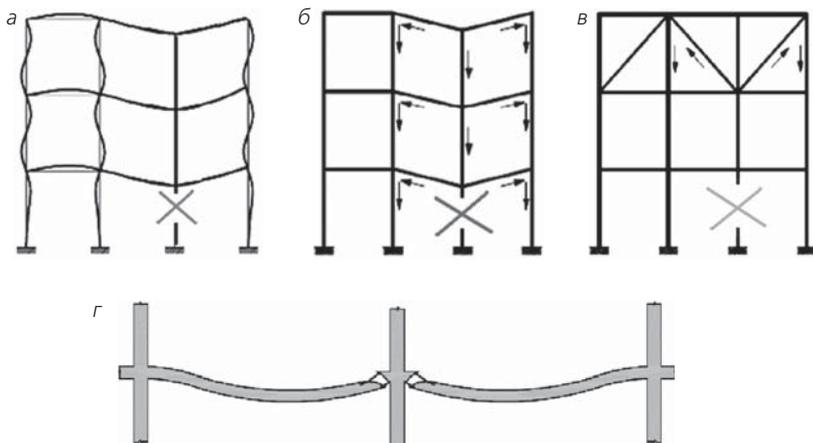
Схемы возможных сценариев работы конструкций при локальном разрушении: а – по типу «балки Виренделя»; б – по аналогии с фермой; в – аутригерные конструктивные системы; г – мембранные эффекты.
